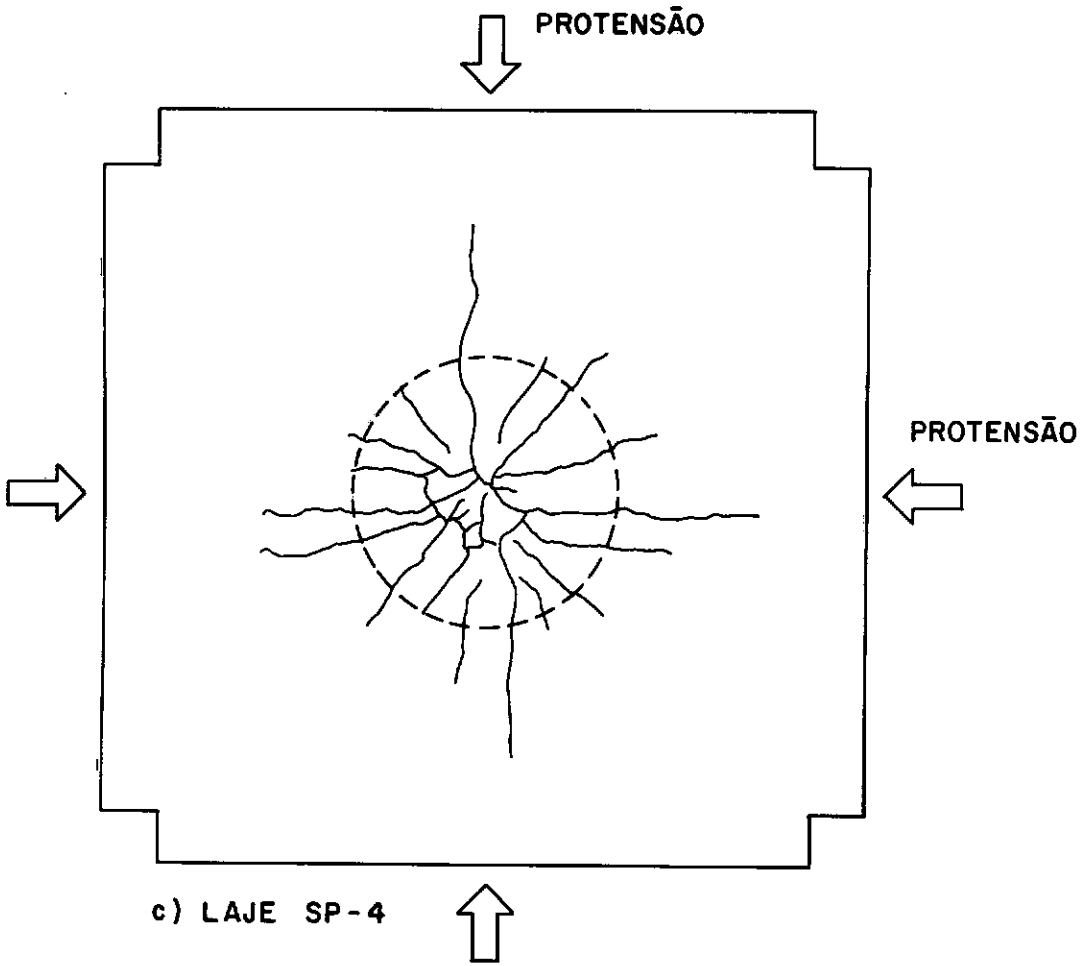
(Cont.) - FISSURAÇÃO DE LAJES ENSAIADAS POR SHEHATA [1]
